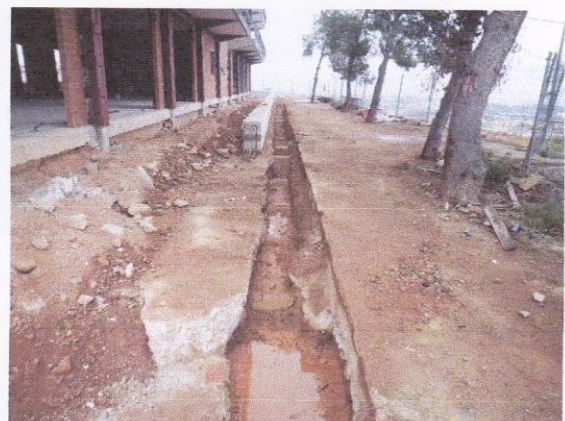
(25/01/11): fachada lateral oeste del edificio T.
